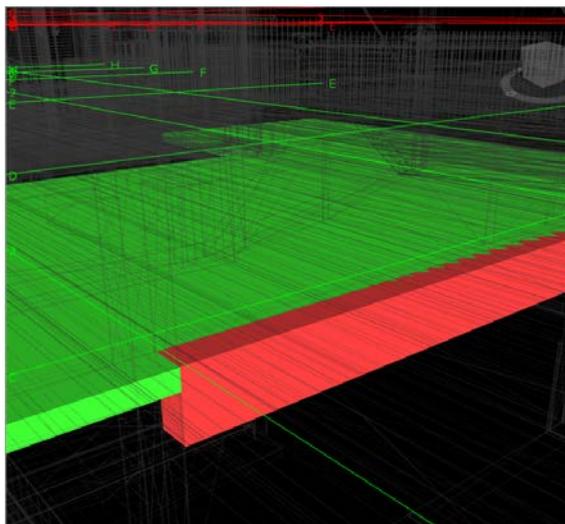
Conflito entre pilar (vermelho) e laje (verde)
